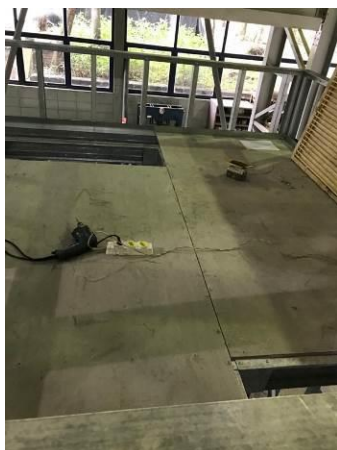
Fixação da primeira camada de placas de fibrocimento.
